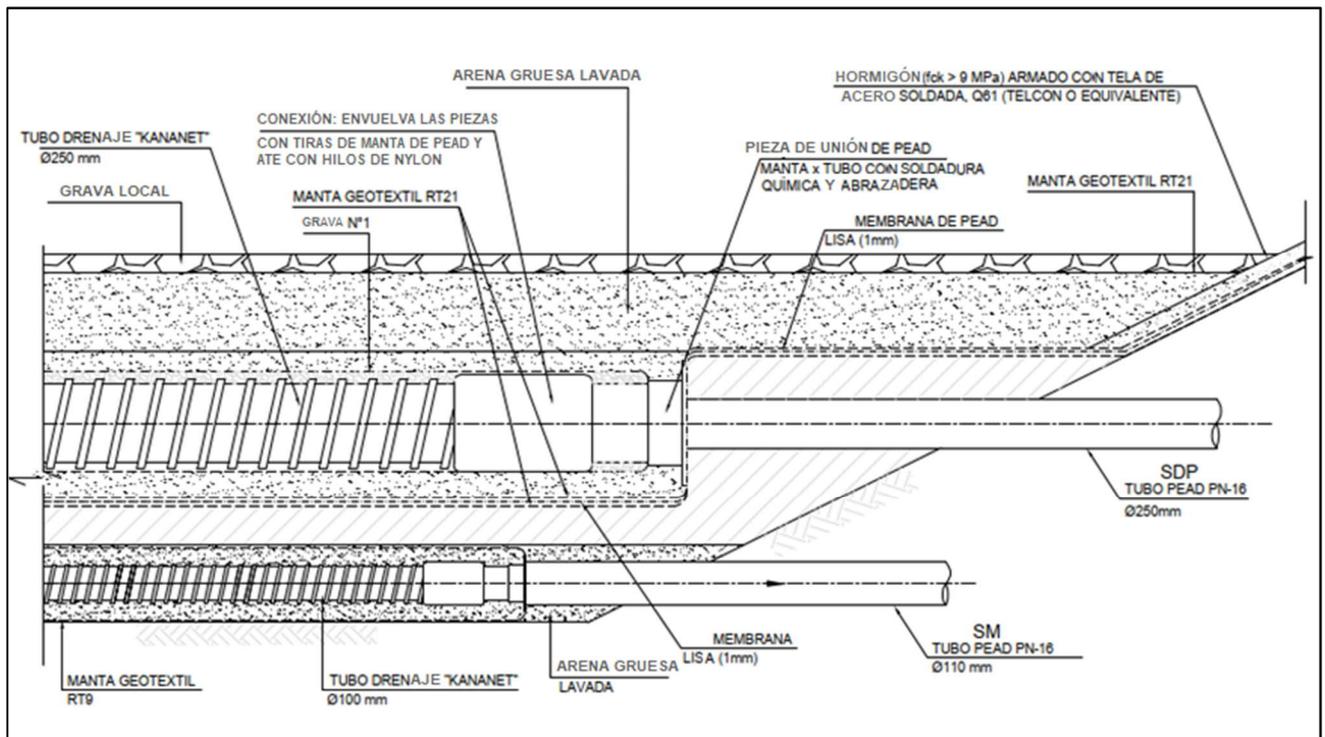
Sistema de impermeabilización de base y drenaje (diseño típico)
